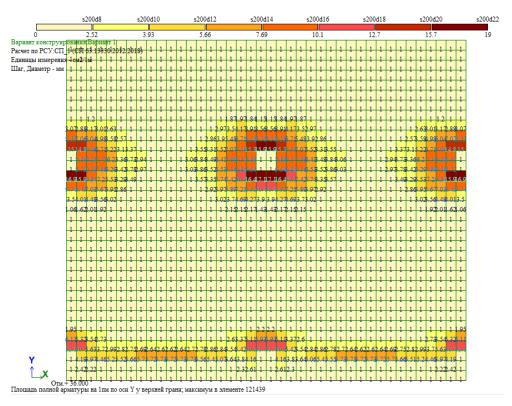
Требуемое верхнее армирование перекрытия по Y после усиления двусторонним наращиванием
